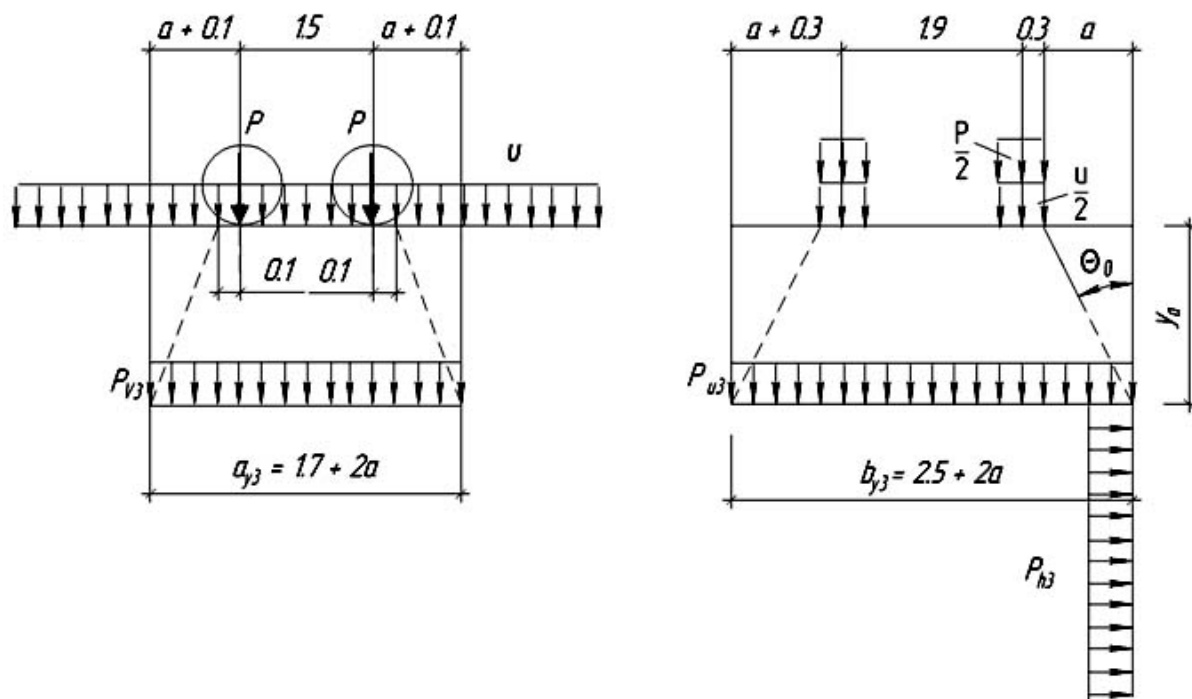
Схема давления от автомобильной нагрузки АК при движении ее вдоль сооружения
